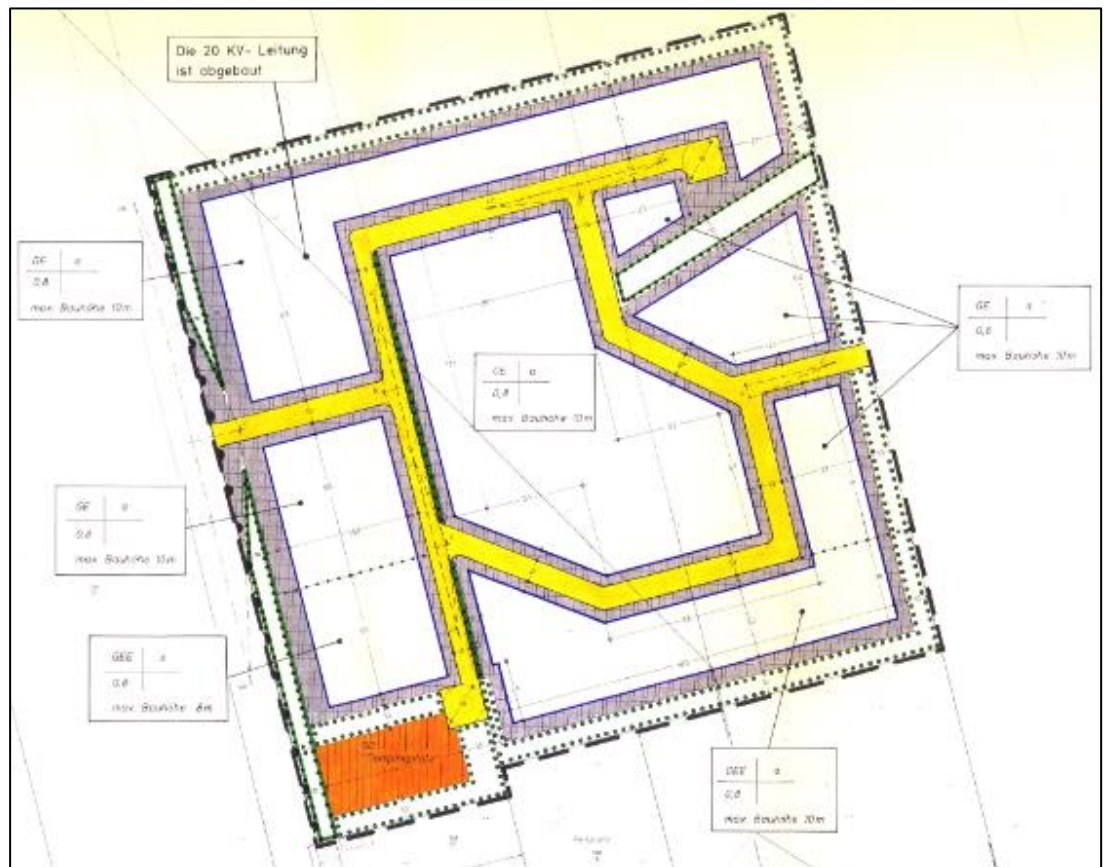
Ursprungsbebauungsplan Nr. 28 „Kirchdamm/ Seehausen“
